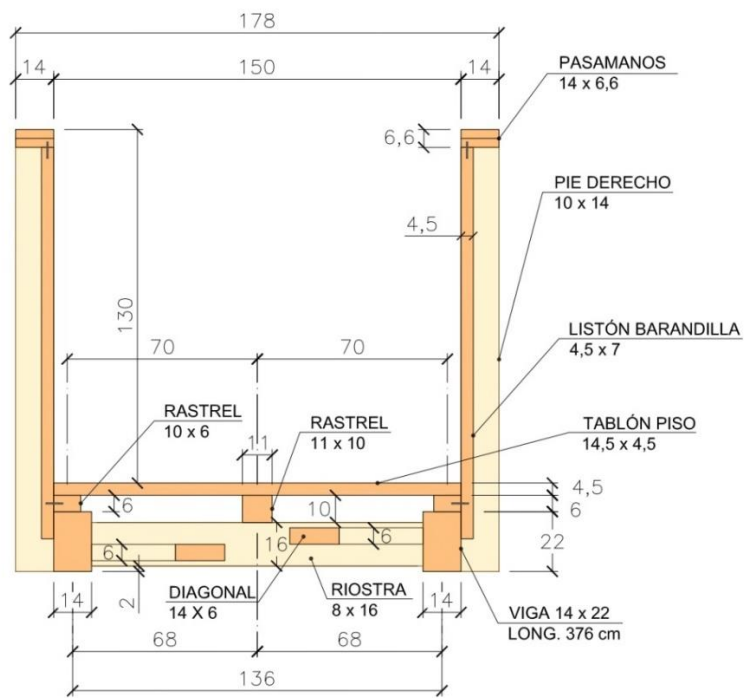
Secciones tipo madera laminada encolada. Fuente: Elaboración propia.
